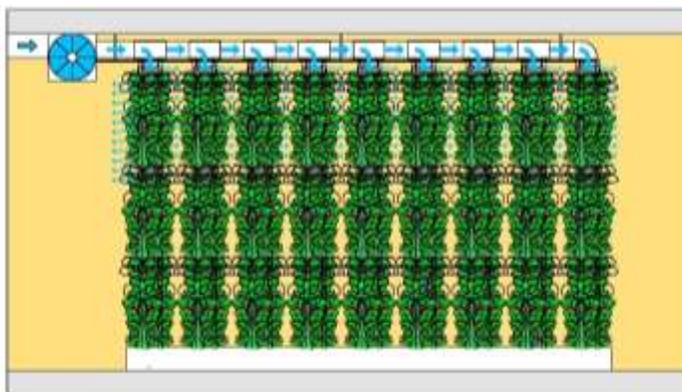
Paso 3 del armado del Sistema. Incorporación de las especies de plantas preplantadas.
